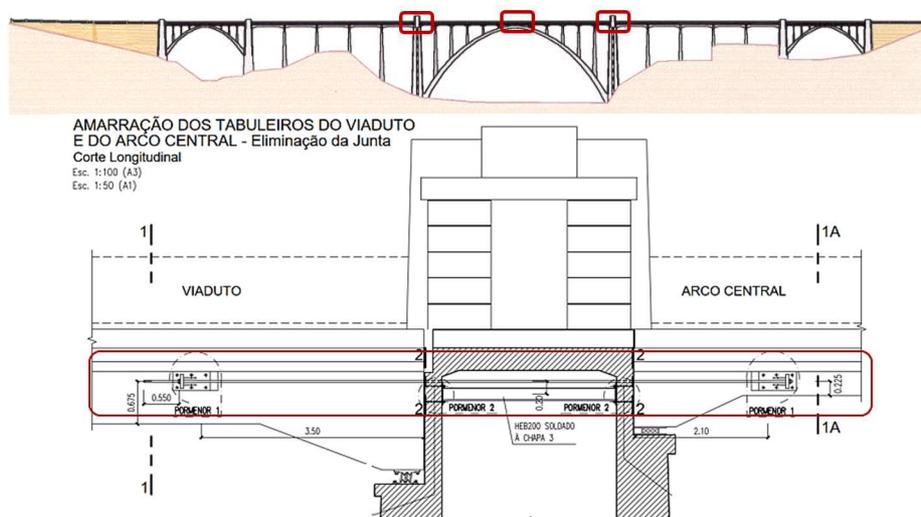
Ligação dos tabuleiros à pilastra com varões de pré-esforço.
